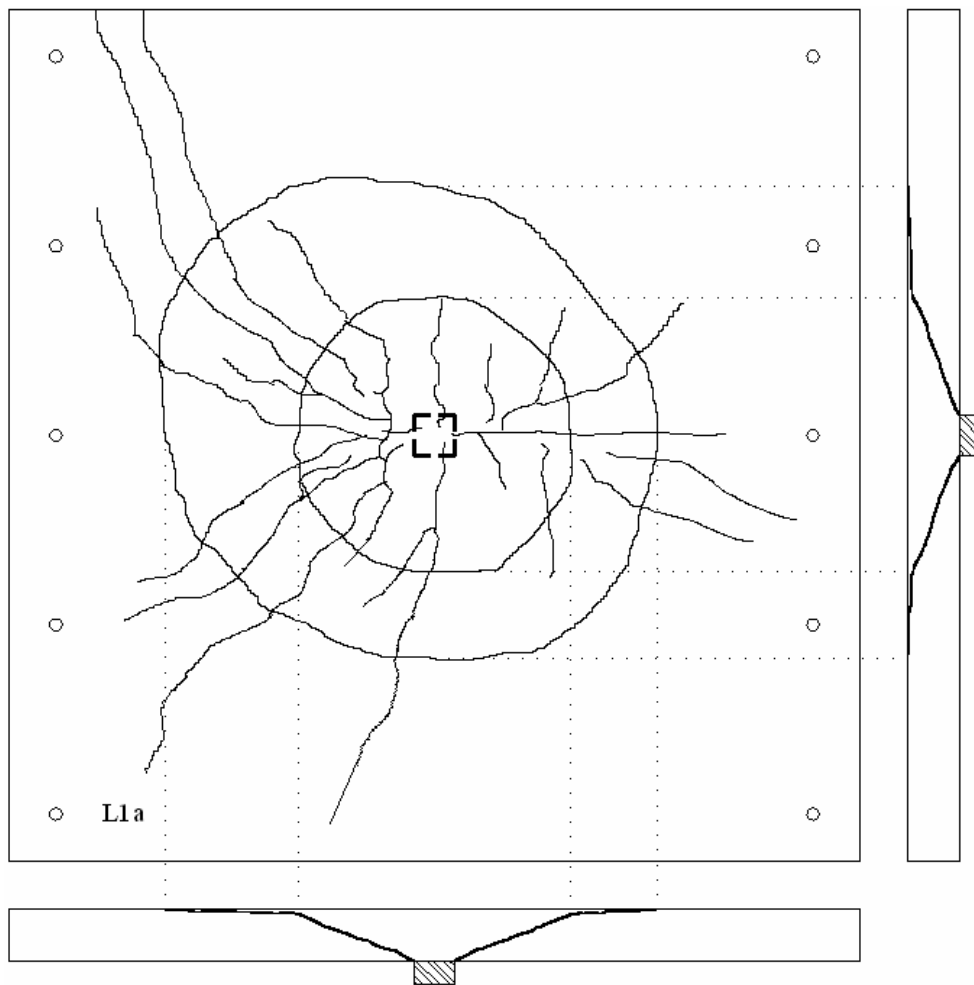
Mapa de fissuração da laje L1a
